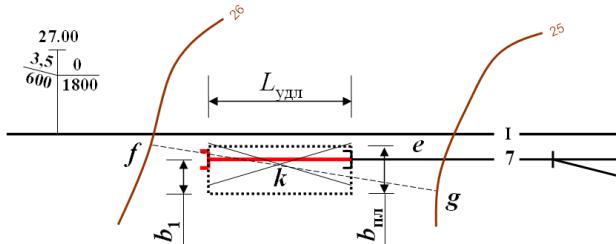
Схема оценки объемов земляных работ по элементарным площадкам
